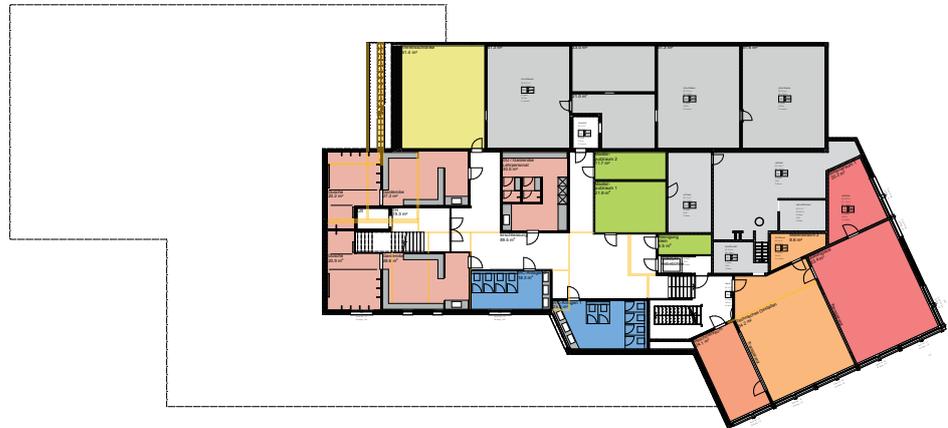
UG Feindispo - Variante 1 + 2, 9.4.25 (Hinweis: Vergrößerung siehe Planbeilage)
